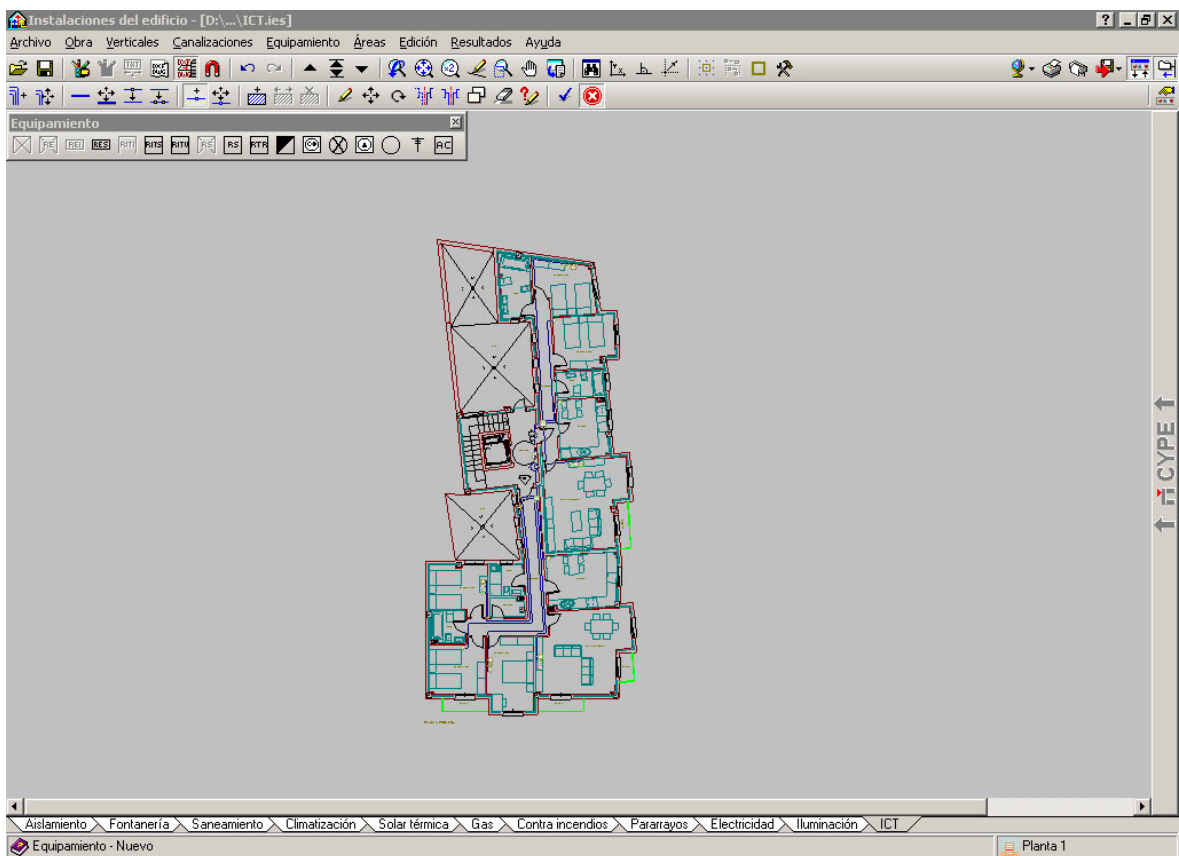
Instalación ICT planta primera (pre-dimensionado)
